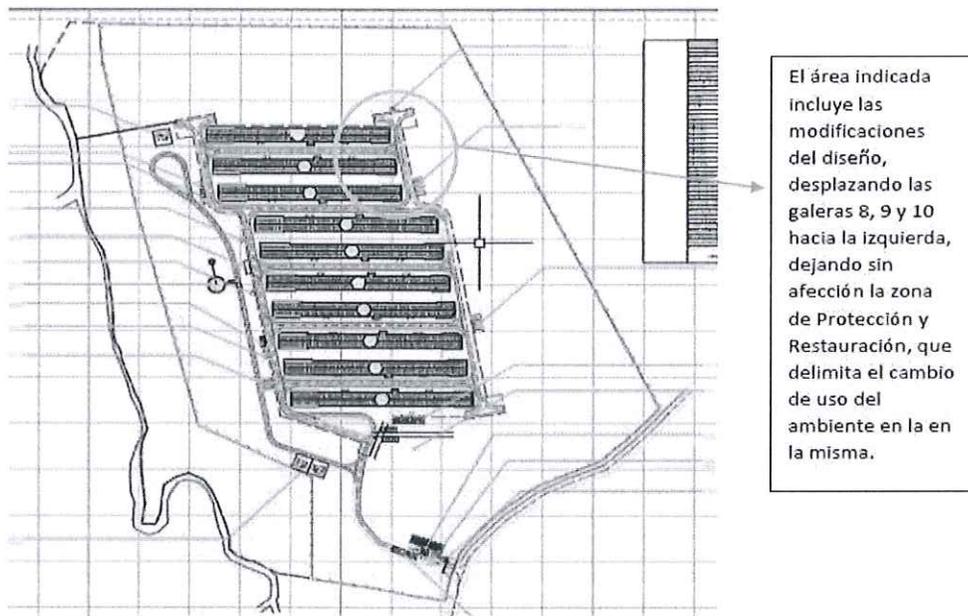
Áreas dentro de la Zona de Protección y Restauración
